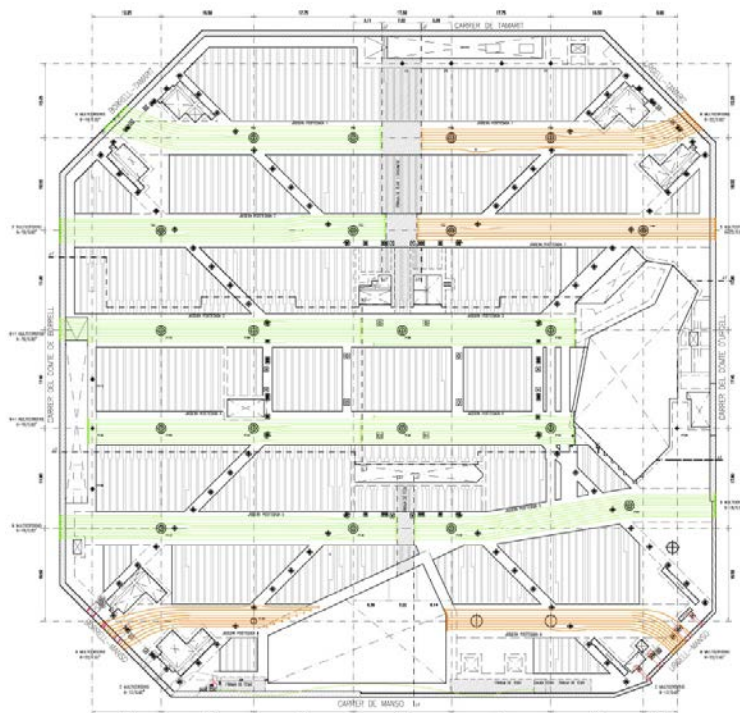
Ejes longitudinales postesados en la losa superior de cubierta (color verde y naranja)
